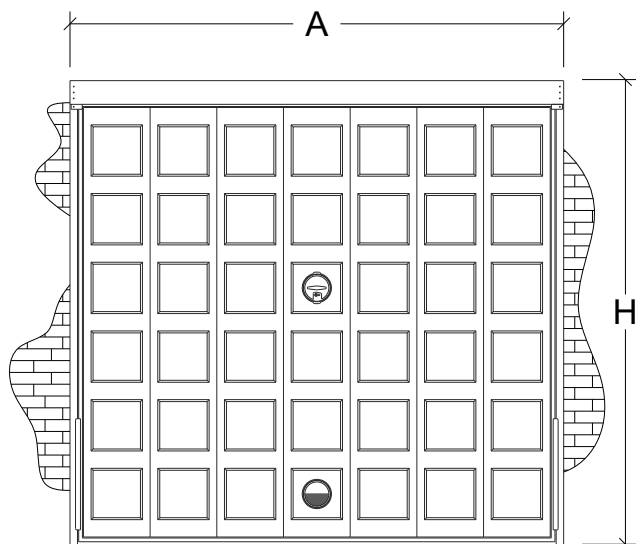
Detalle de alzado de Puerta Standard Cuarterones
